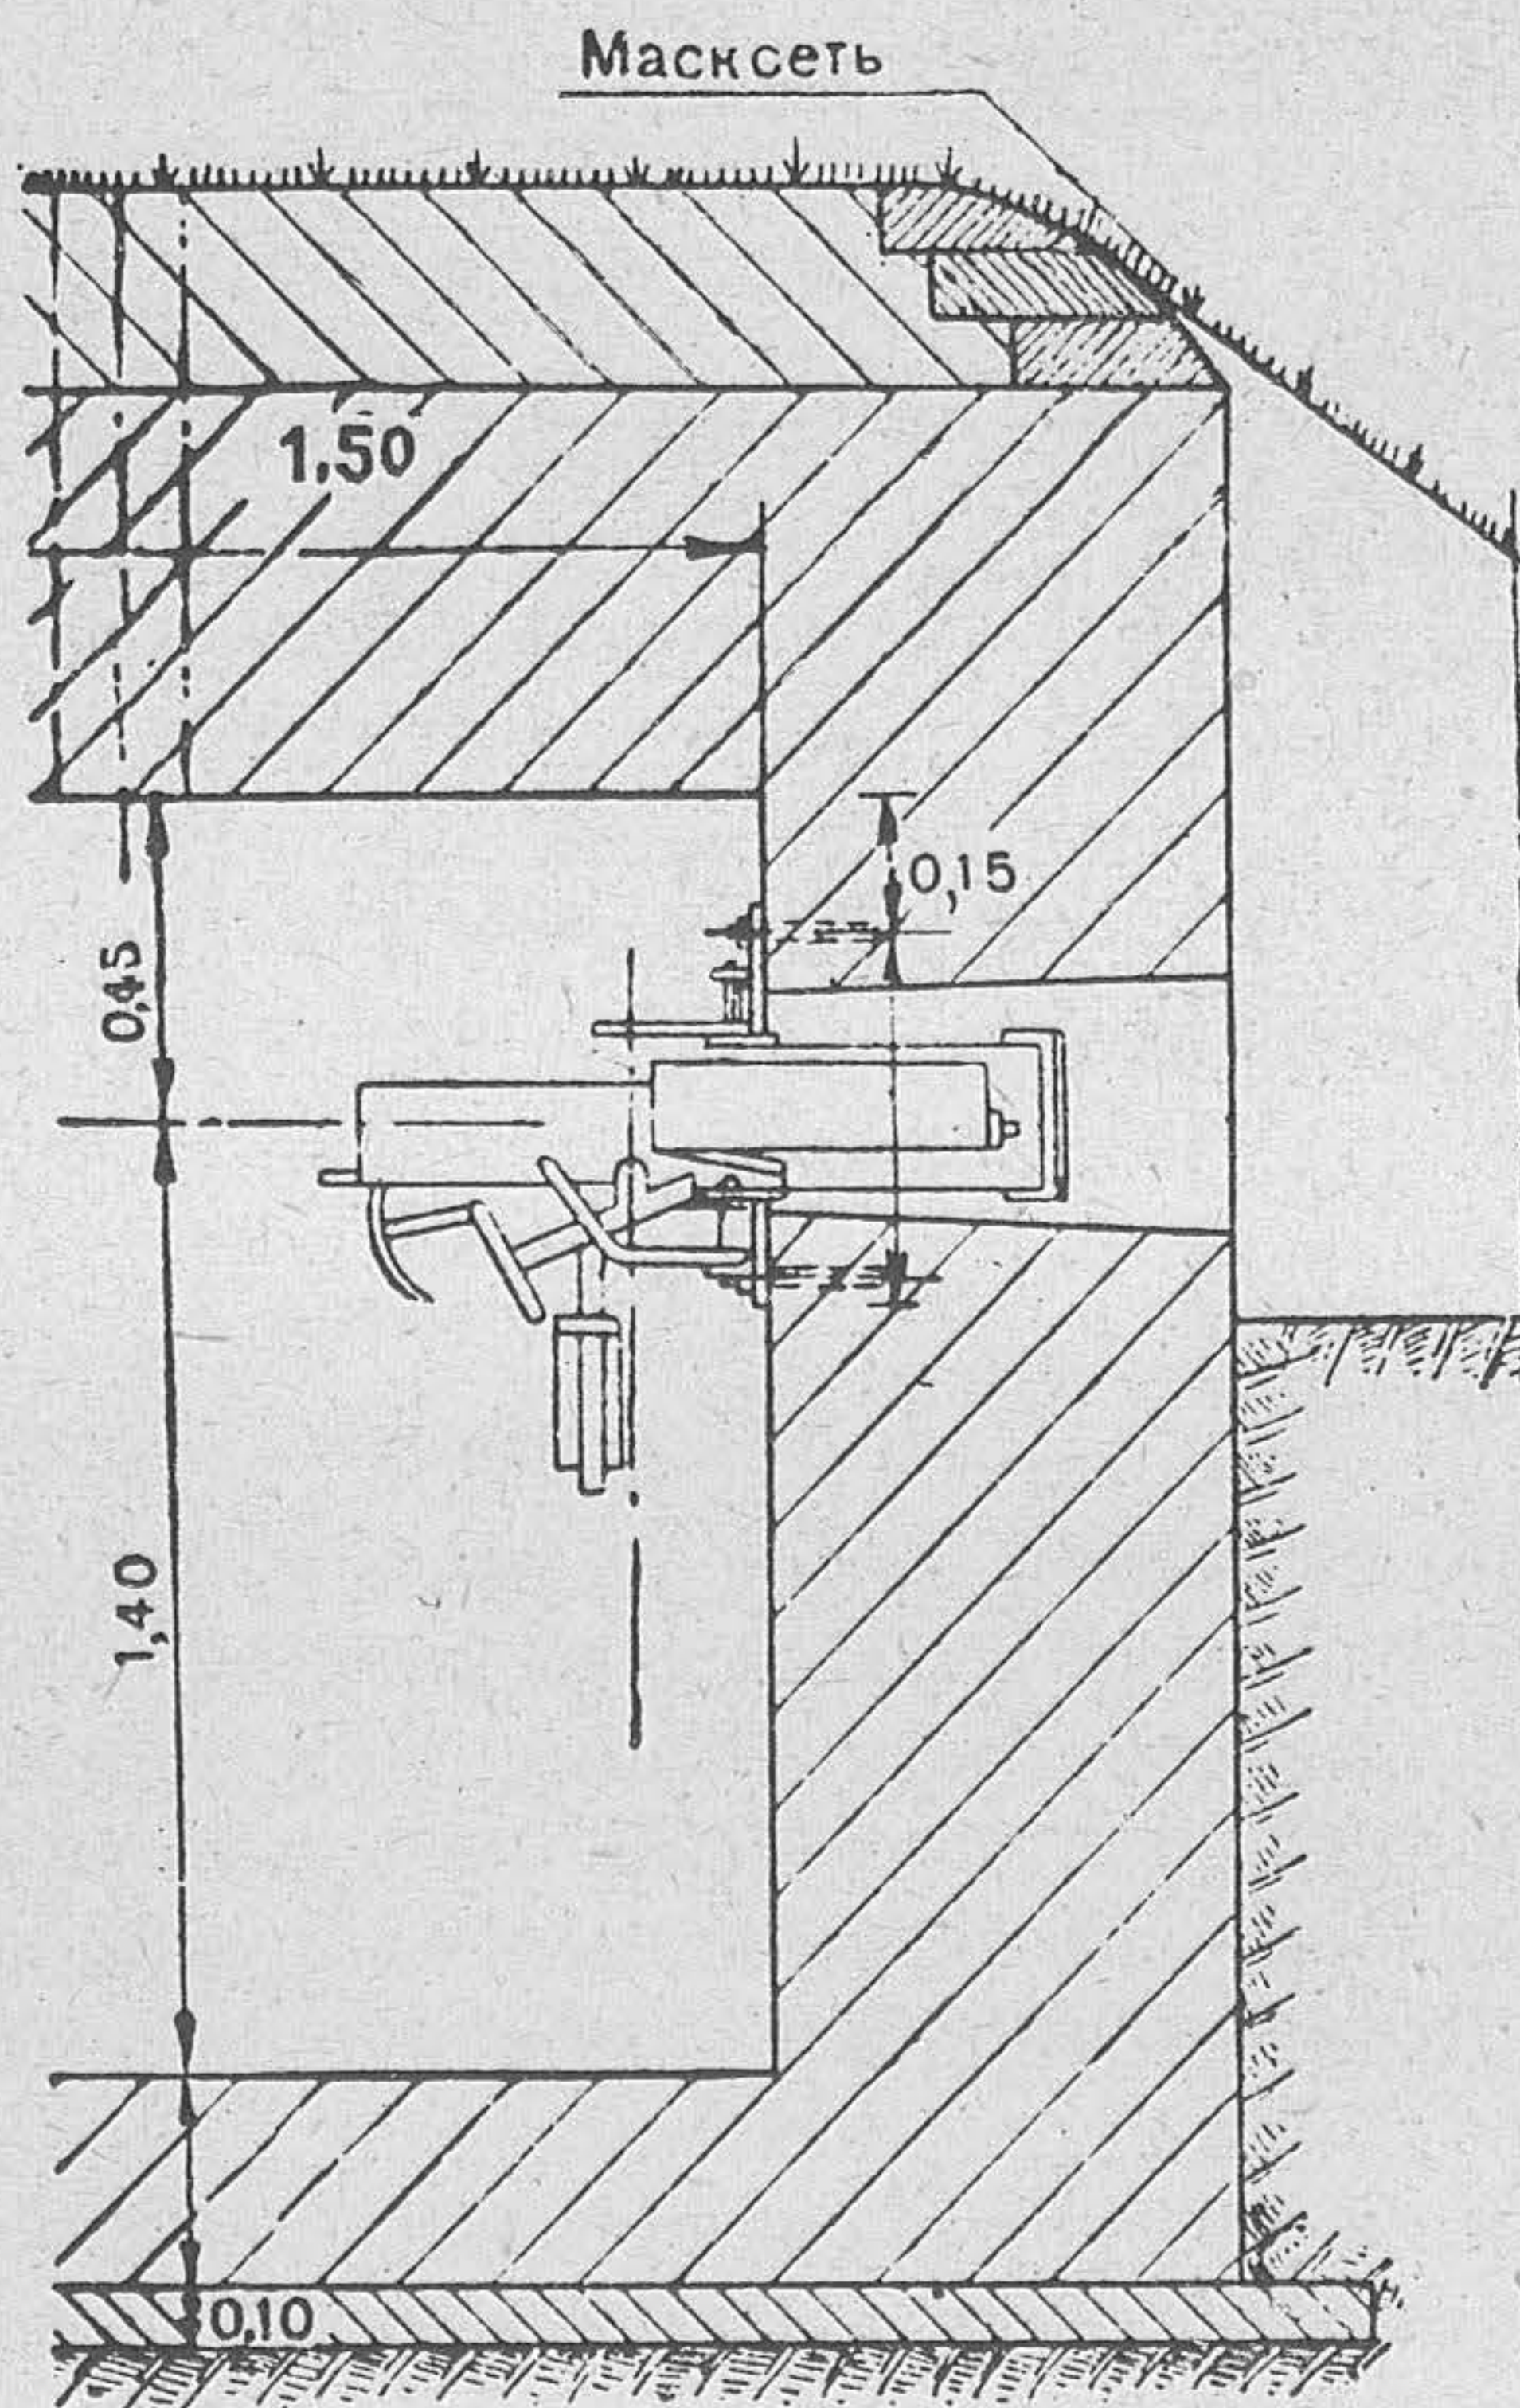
Установка пулемёта на настенном станке в железобетонном сооружении
